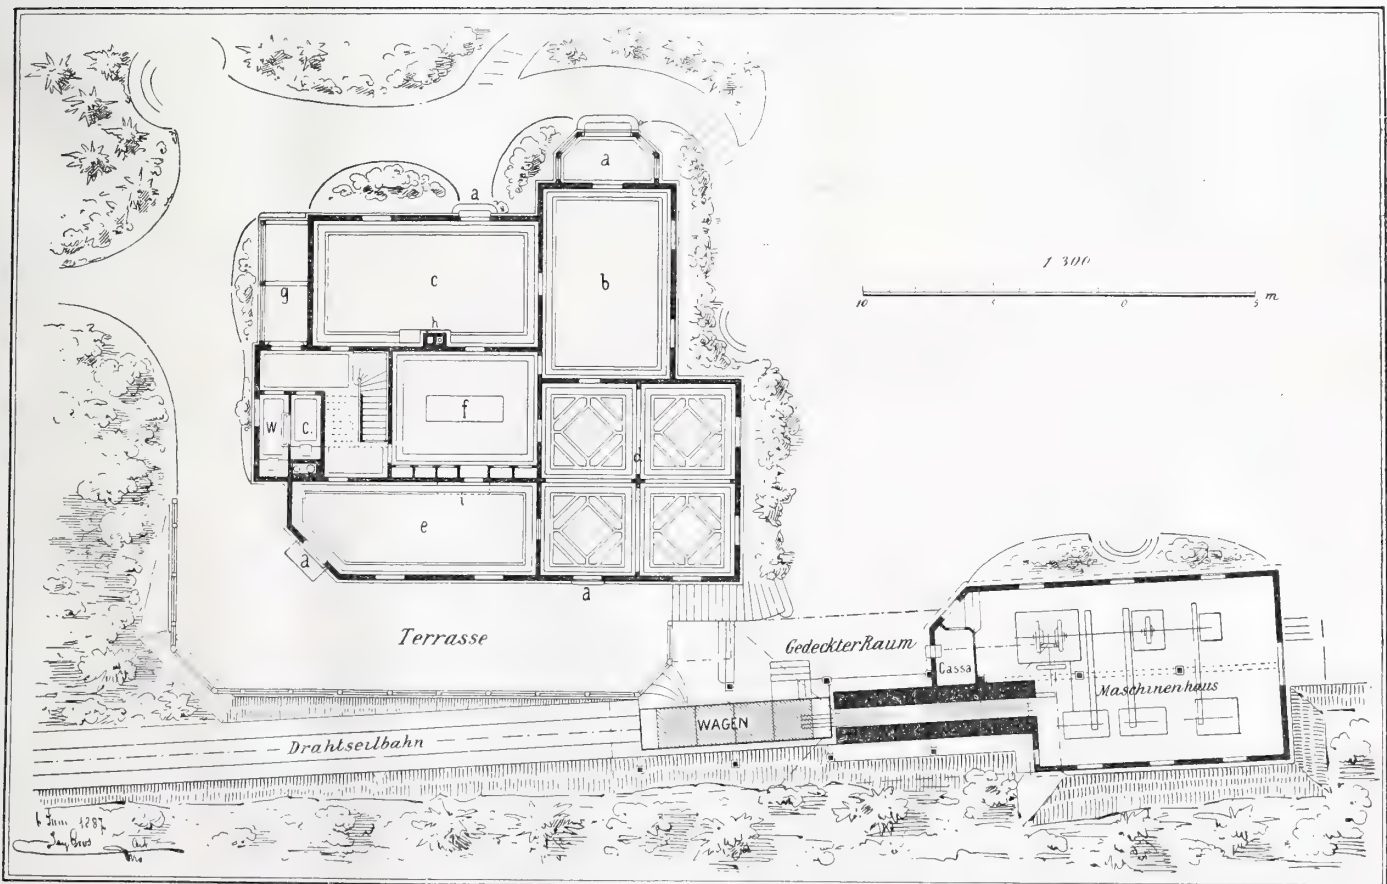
Grundriss vom Erdgeschoss.
